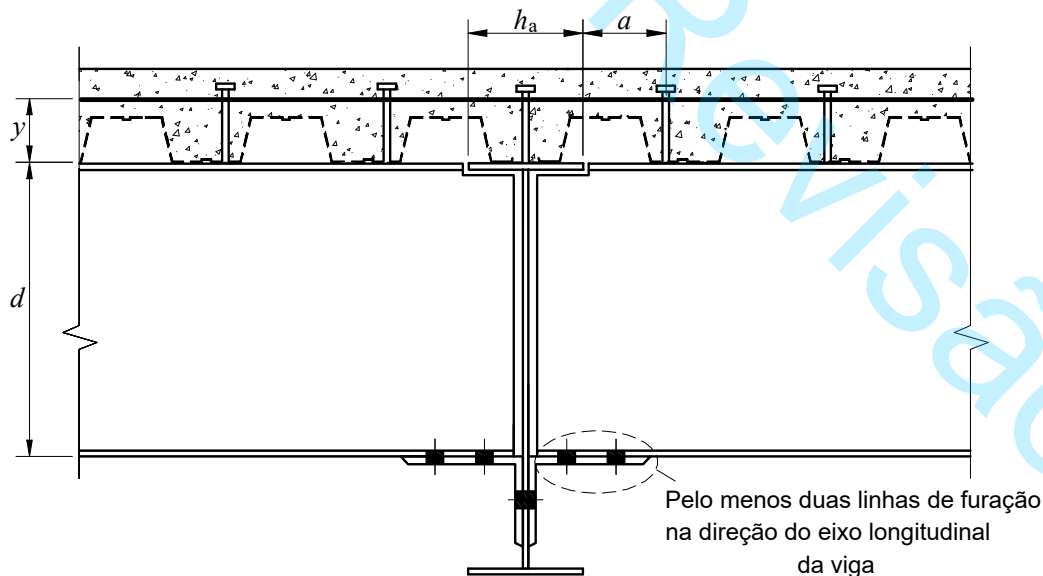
Ligação mista com cantoneira parafusada na mesa inferior da viga apoiada
